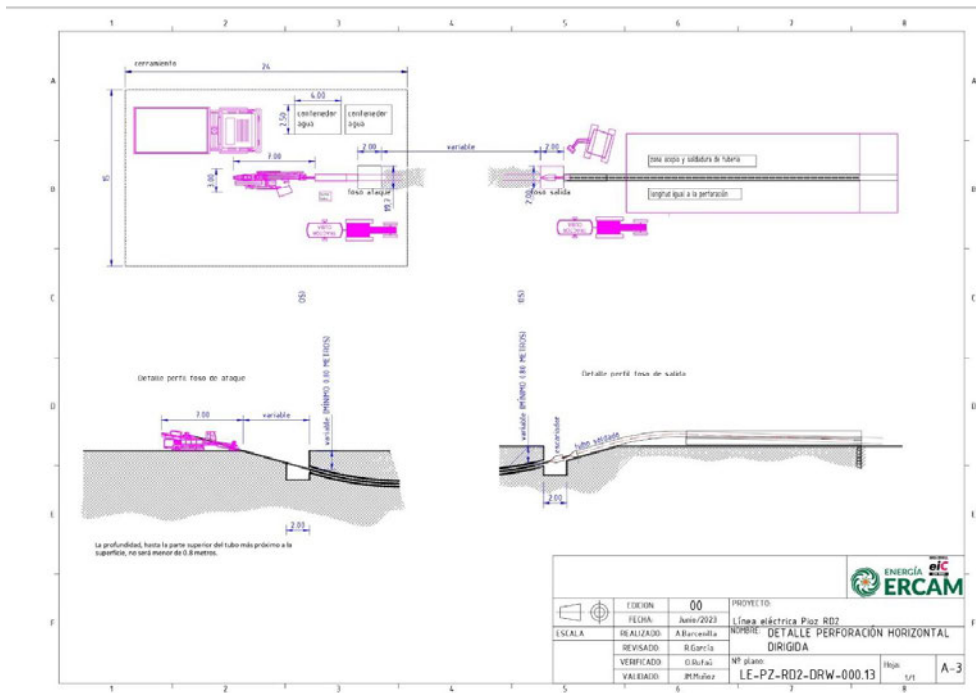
Plano detalle del paso soterrado por el río Henares
